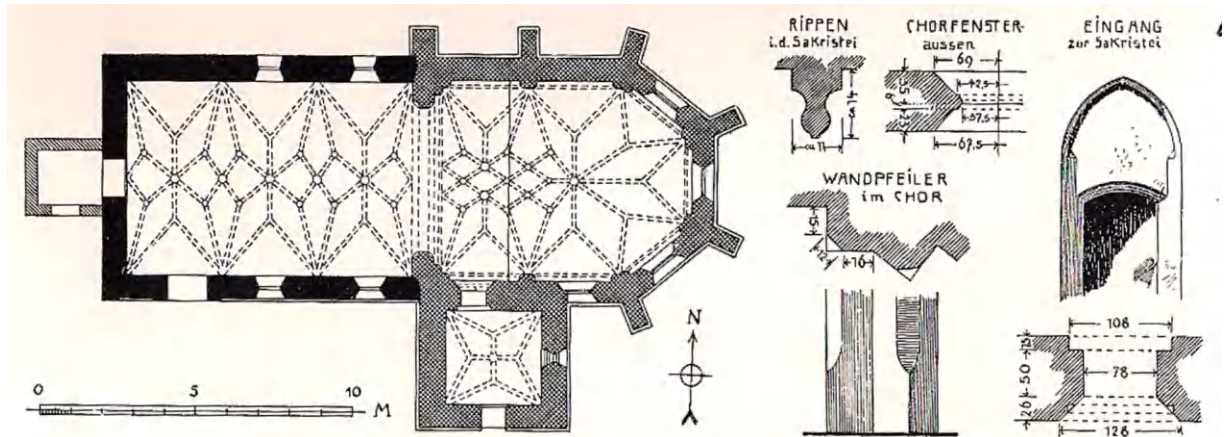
Vilssattling. Kirche. Grundriß und Teilformen.
